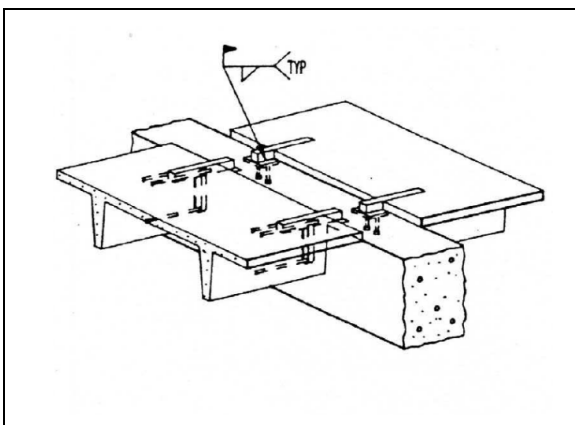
Ligação de lajes duplo “T” em vigas quadradas, através de chapas soldadas aparafusadas, em paralelo com a laje (PCI).
